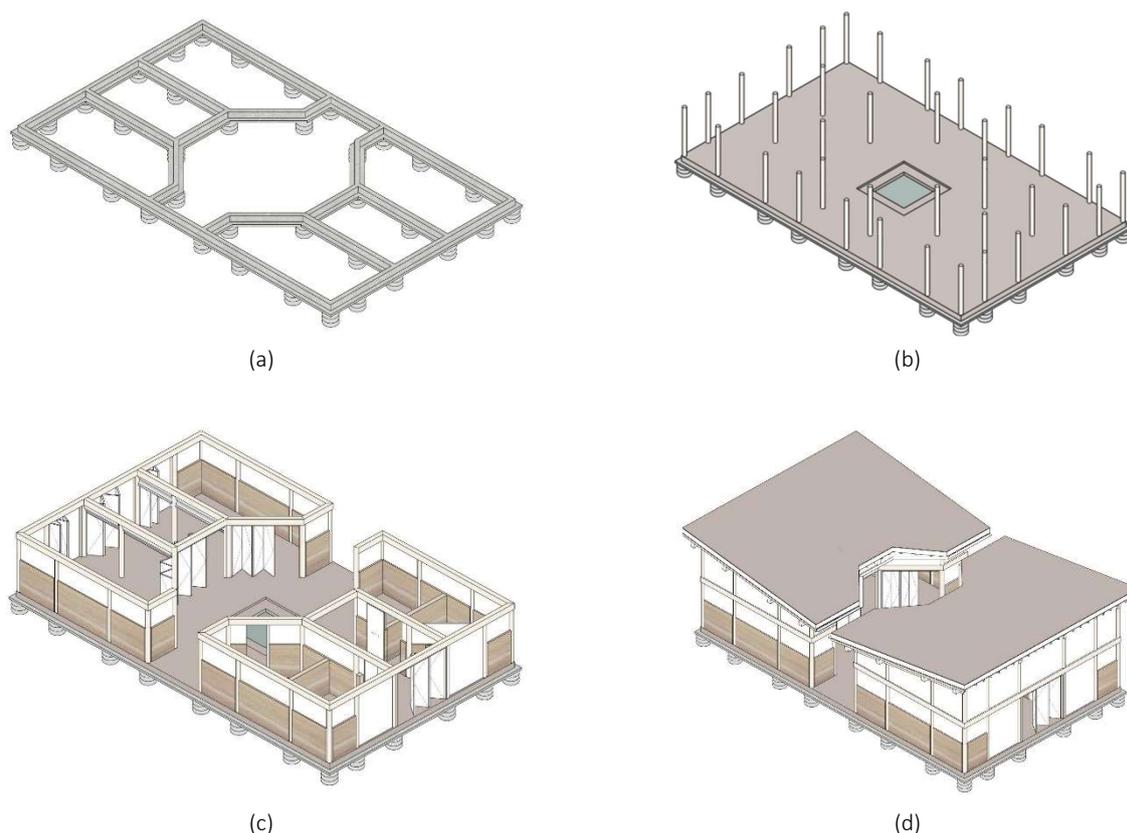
Etapas construtivas da proposta: a) Fundação de pneus e vigas de baldrame; b) Locação dos pilares roliços em madeira; c) Fechamentos de taipa estabilizada (inferior) e painéis de bambu (superior); d) Cobertura de camadas de bambu ou palha coberta por fina camada de terra estabilizada. FONTE: Elaborada pelas autoras.
